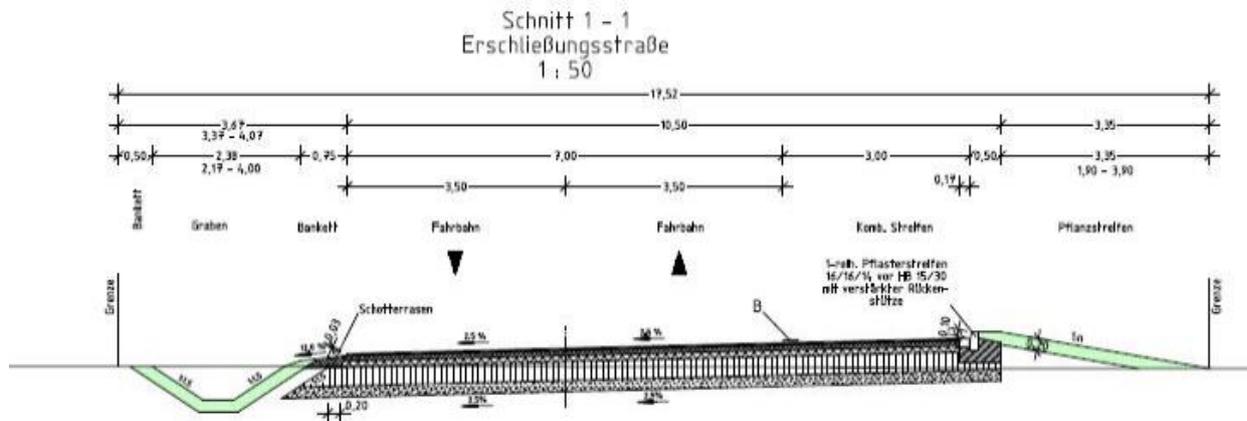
Straßenquerschnitt Verlängerung Hauptplanstr. / Abschnitt nördlich GE 1
